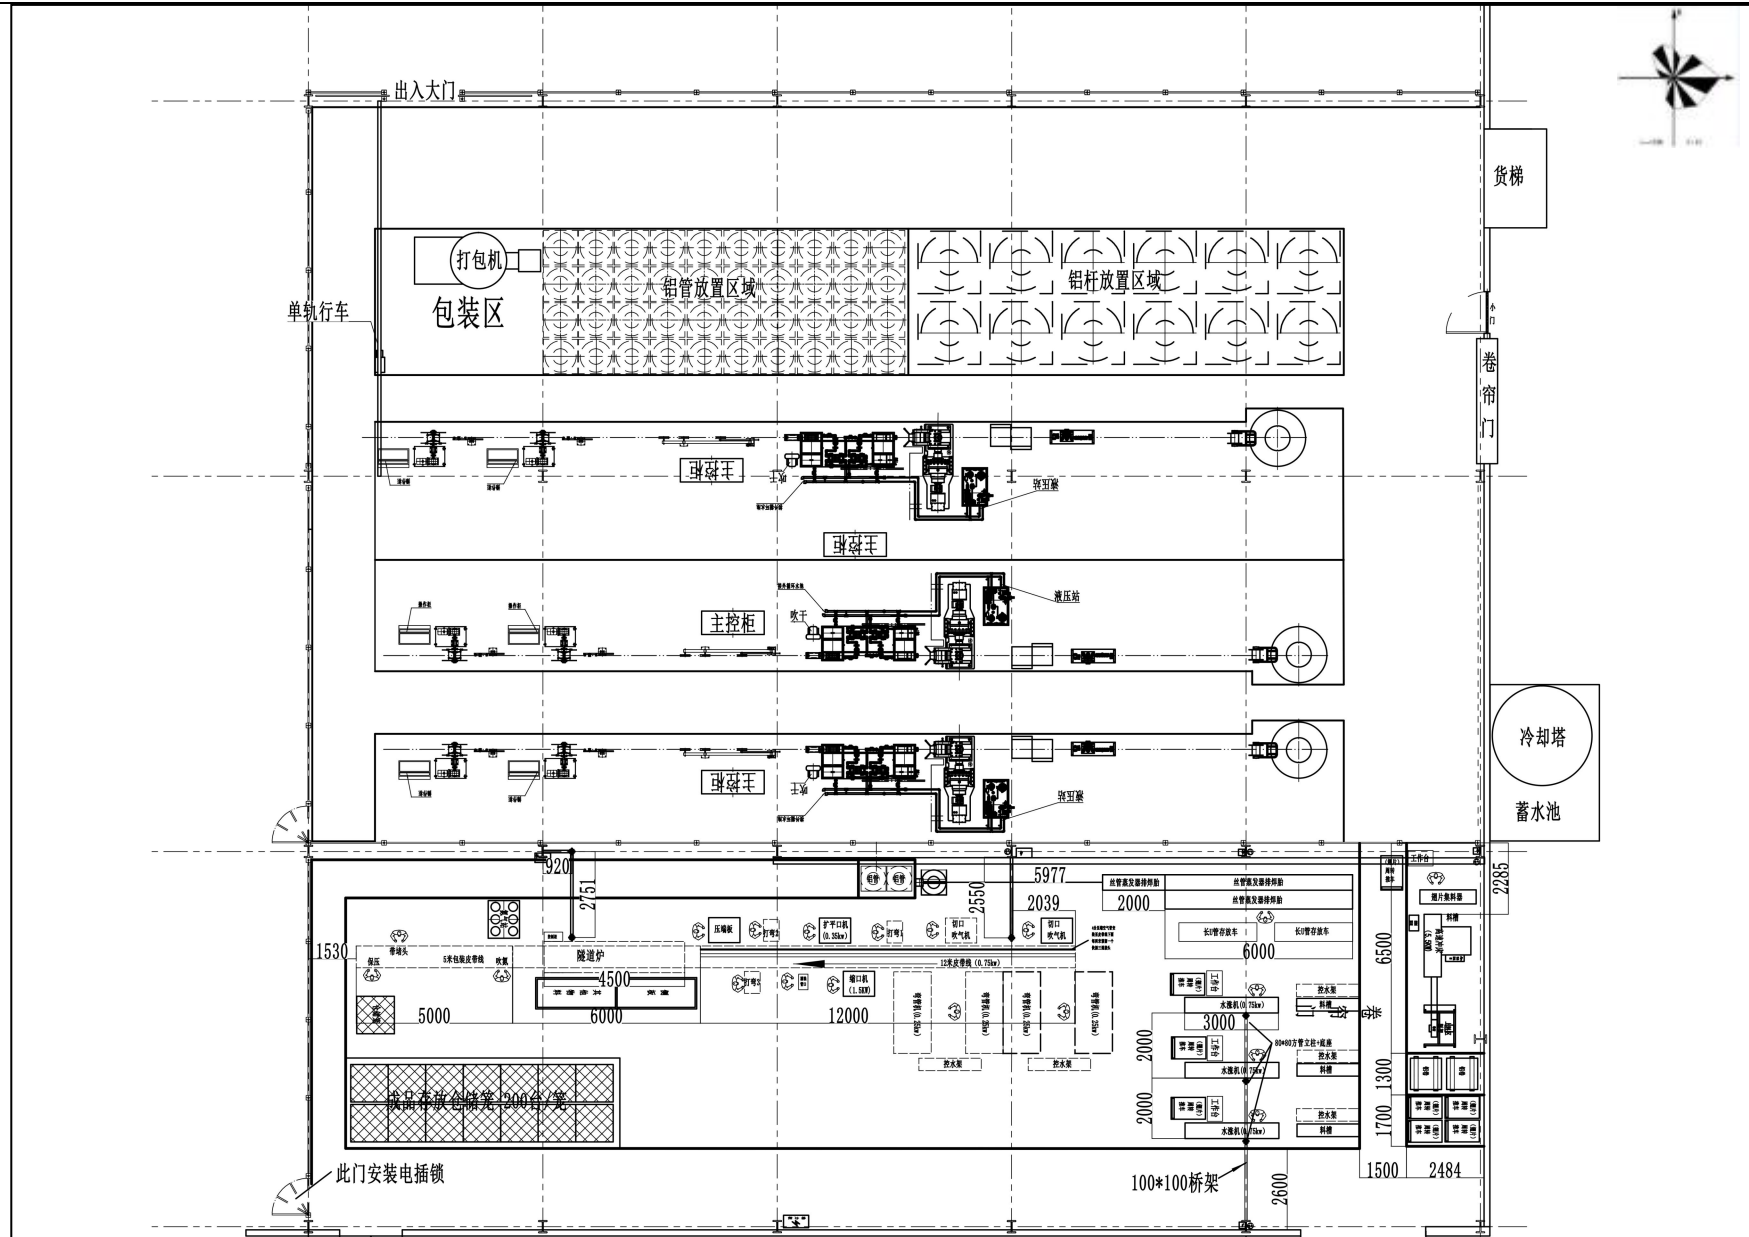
合肥盛邦电器有限公司厂区总平面布置图
